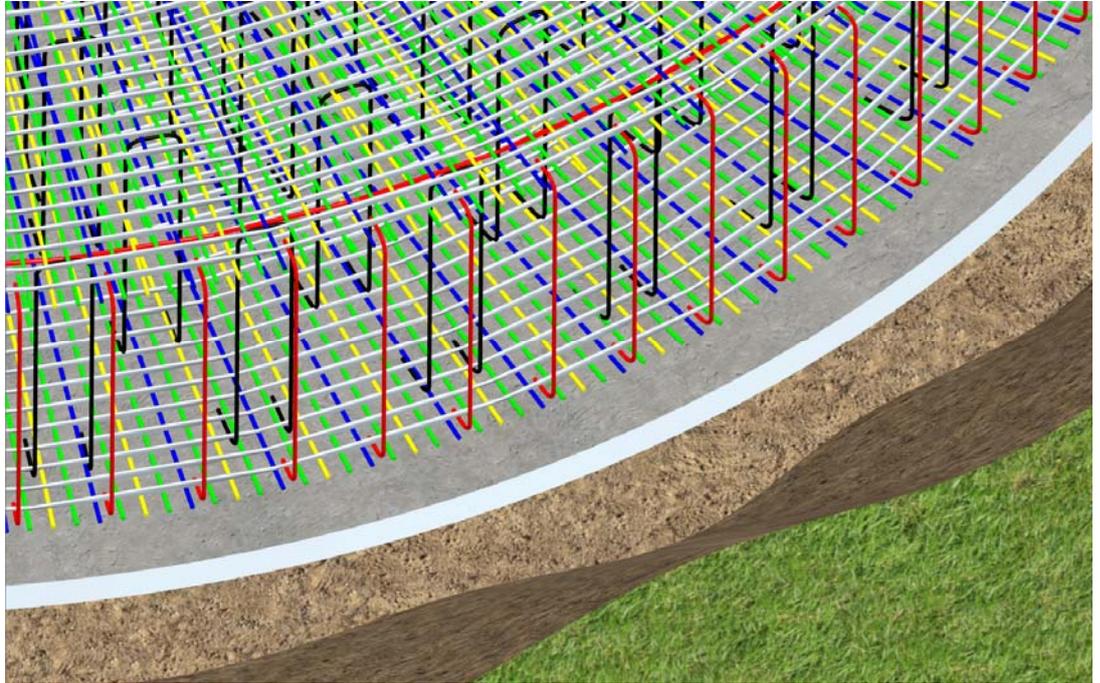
An der Außenkante installierte Randbewehrung Pos. 7.1.
